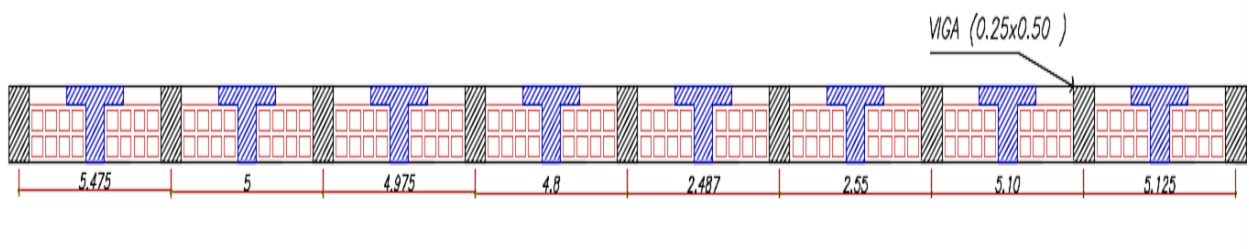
Análisis de la viga T en el eje C-D, Tramo 1-9
